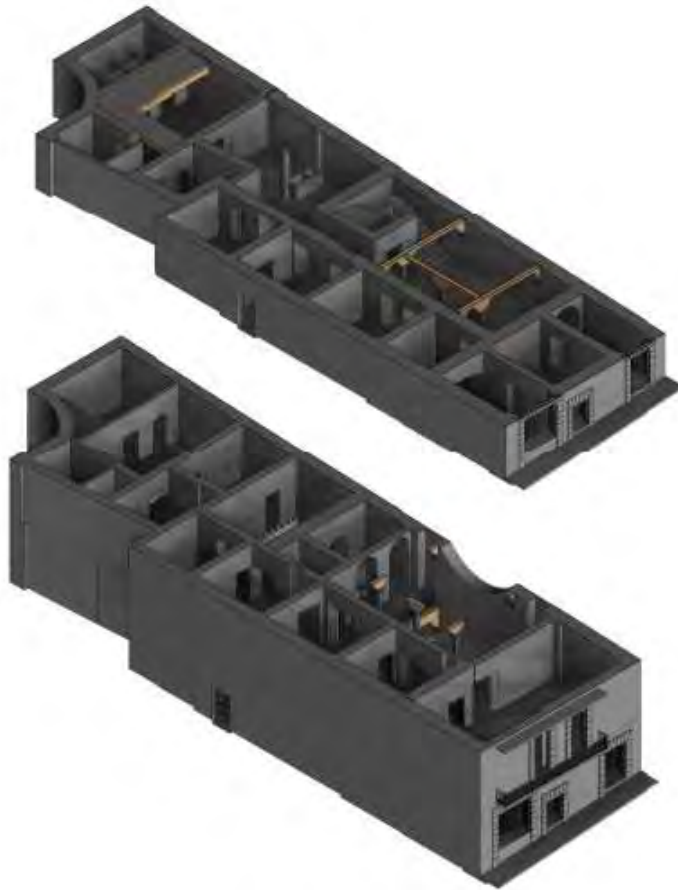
Isométrico volumétrico de la CAMEM en donde se puede observar la conformación espacial interior en conjunto con la fachada principal y la fachada norte en donde está la conexión con el Museo del Estado. La figura de arriba es la distribución de la planta baja y en la figura de abajo se encuentra la de la planta alta. Fuente: Isométricos elaborados por METR septiembre 2020.
